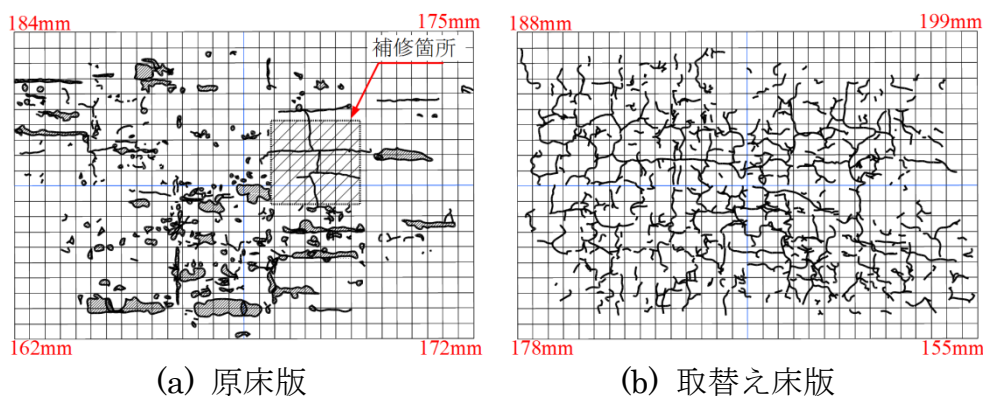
床版下面ひび割れ発生状況(載荷試験前)
